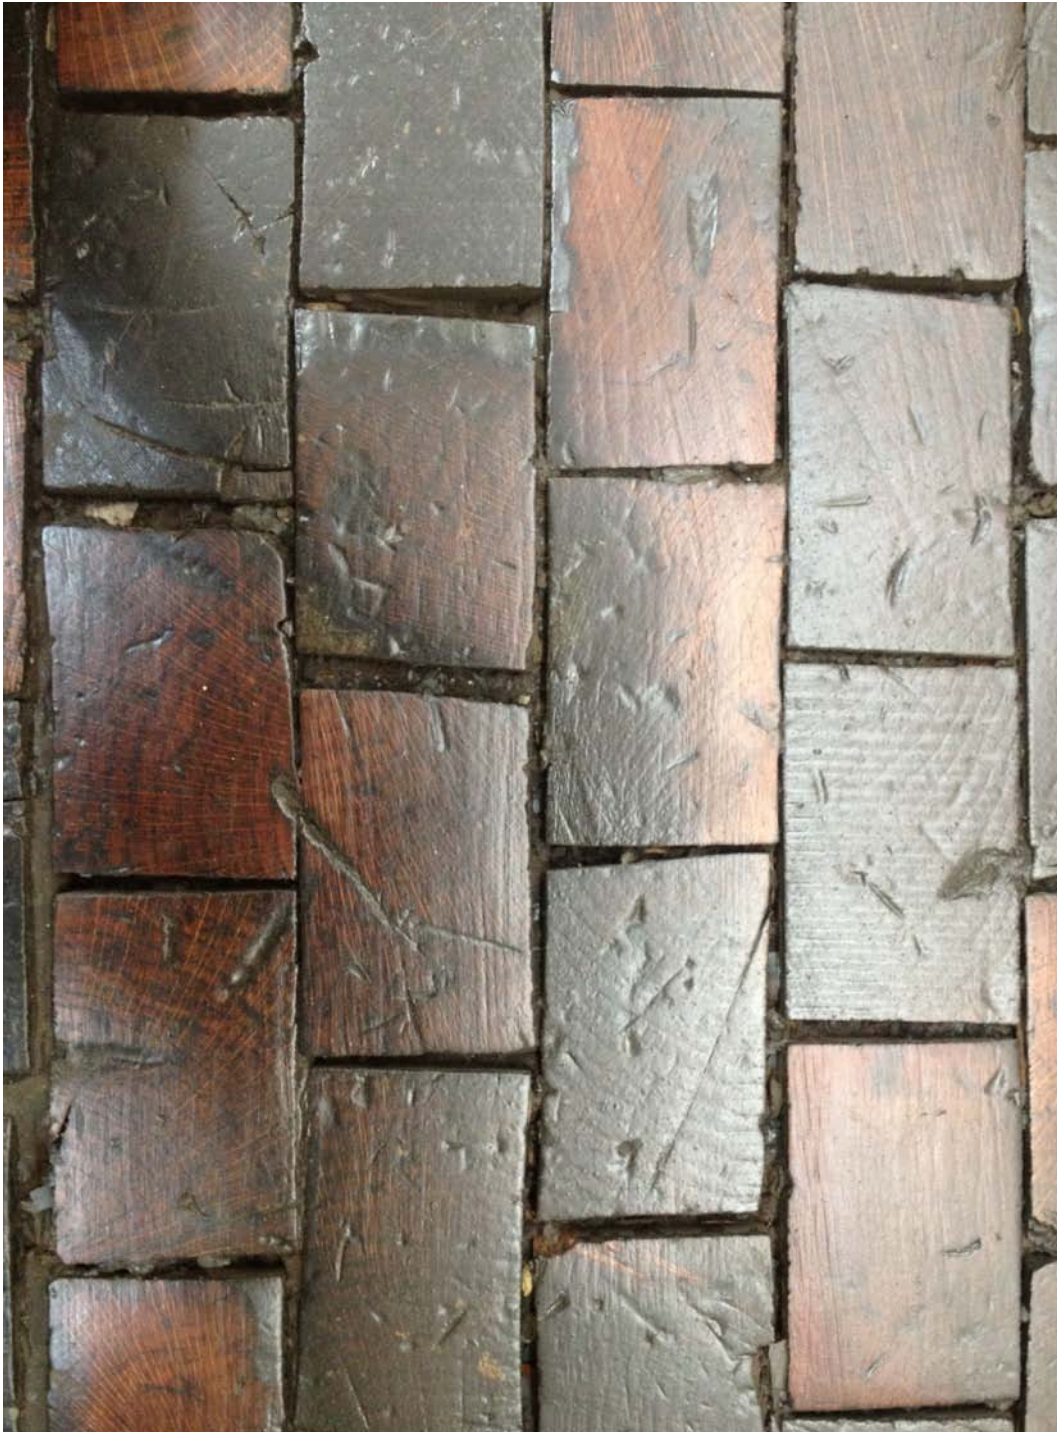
Particolare pavimento in legno di testa.⁽¹⁾
